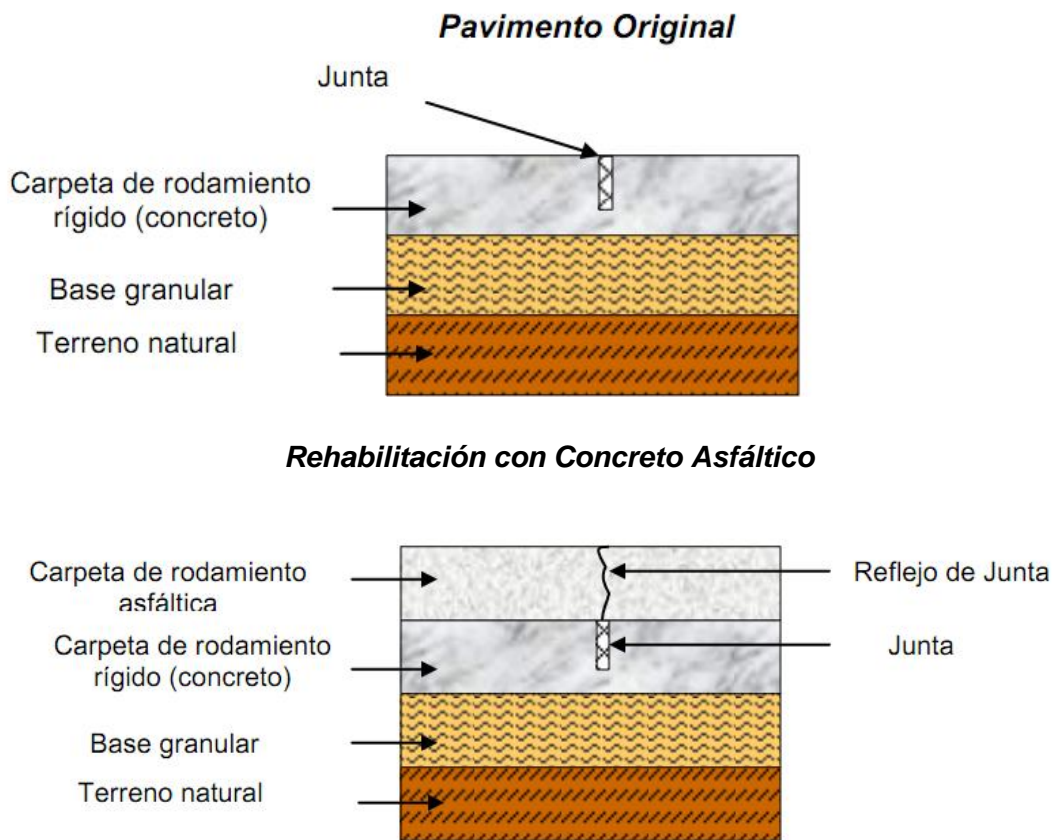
reflejo en Juntas y Grietas.
